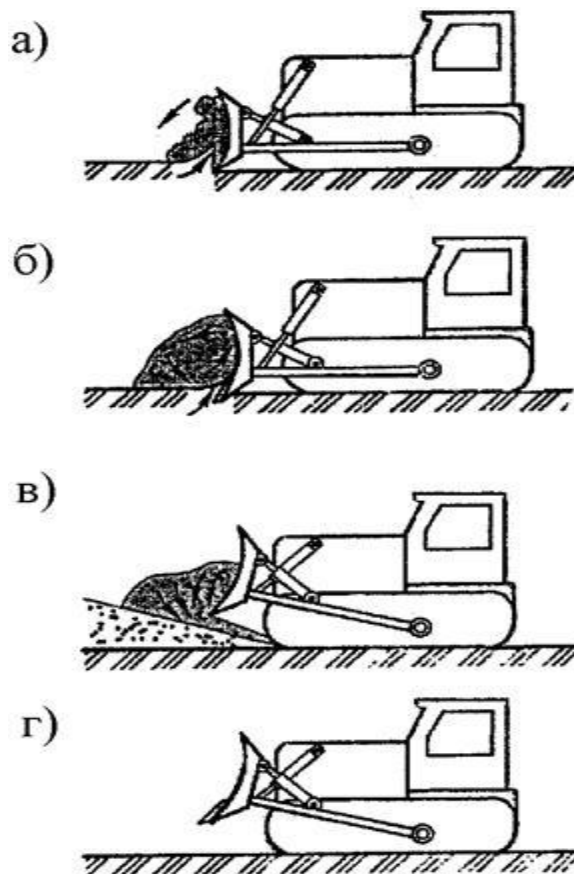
Схемы работы бульдозера при разработке грунтов: а – резание; б – транспортирование с подрезанием; в – отсыпка; г – откат назад (холостой ход).
